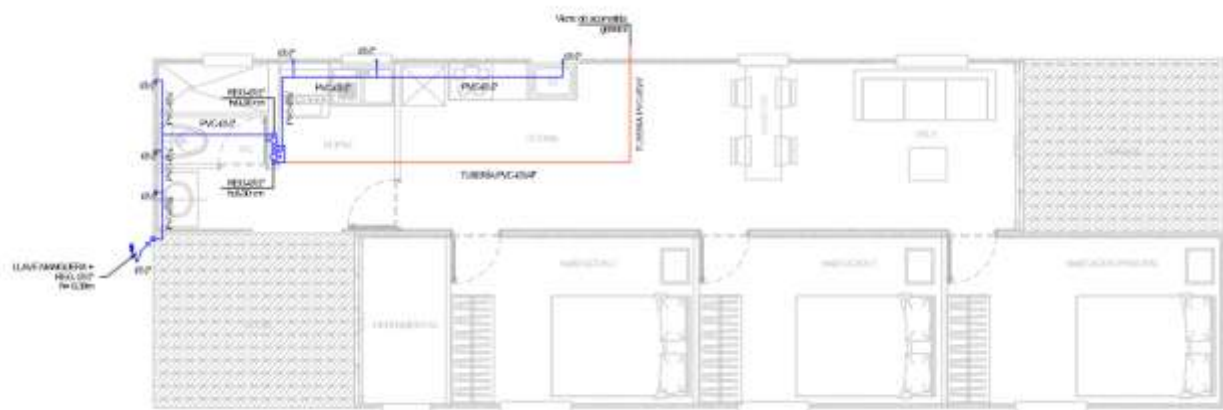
, Planta Diseño hidráulico #1, 2025-II, Wilson Lozano
